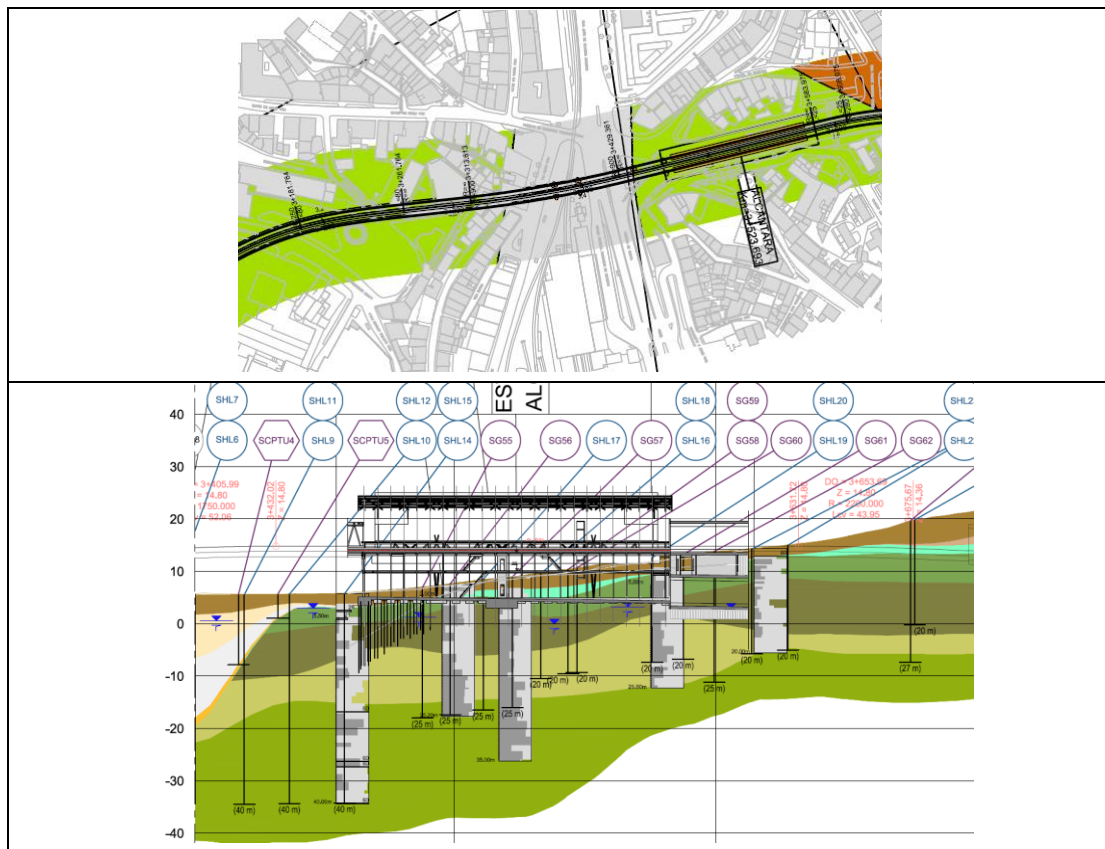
Planta e perfil longitudinal – Geologia / Geotecnia
